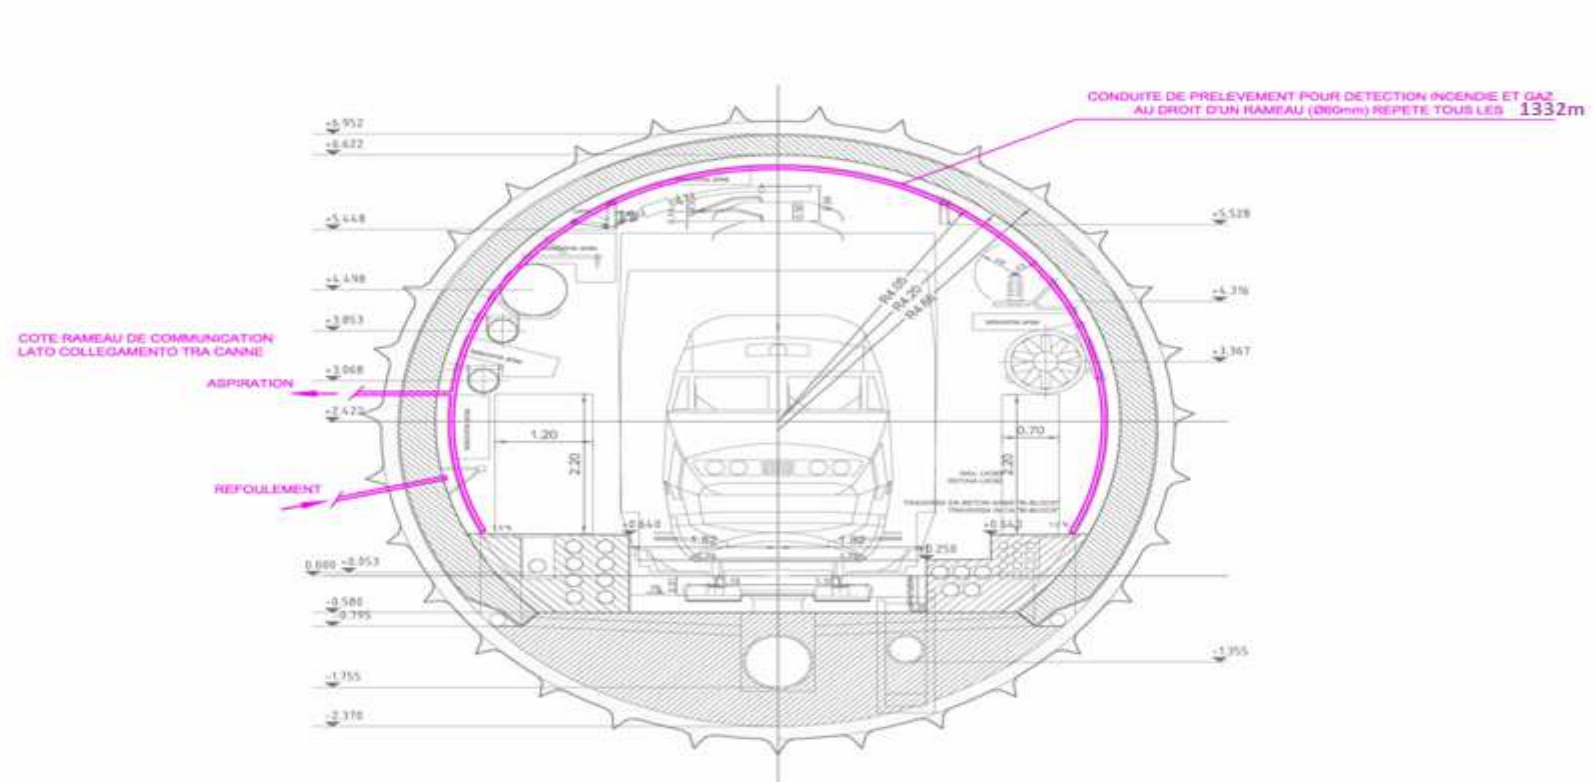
Coupe type en tunnel pour le système de prélèvement
